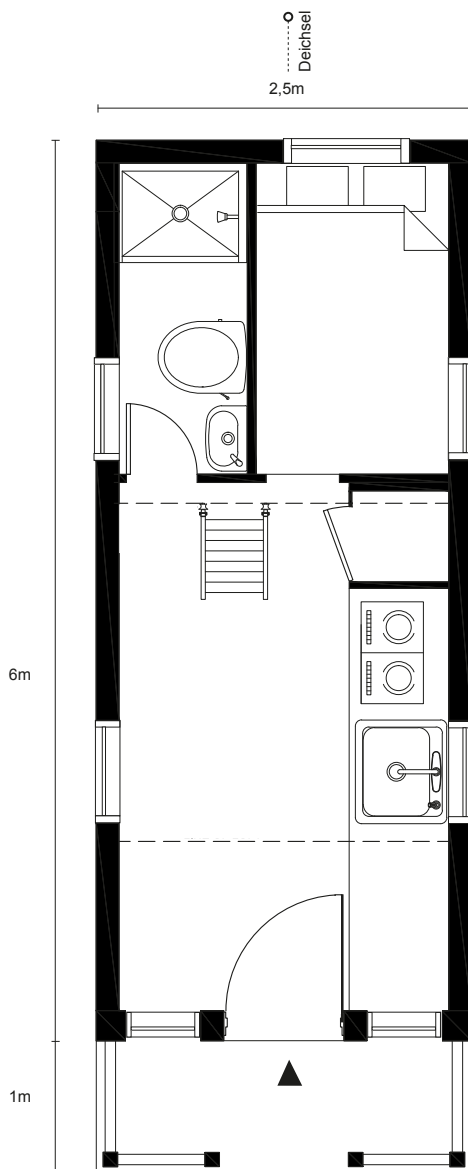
+ 20: adaptierte Grundrisse „Linden“<sup>50</sup>
